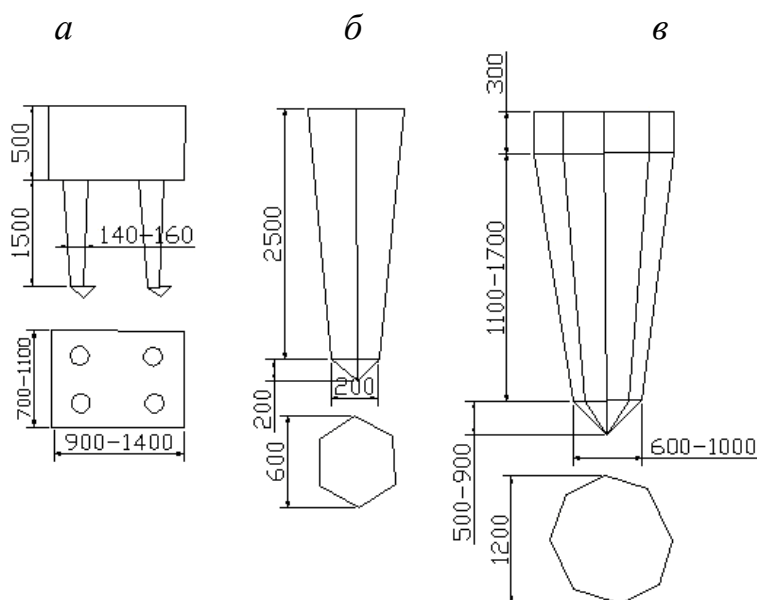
Виды набивных фундаментов с уплотненным основанием:
